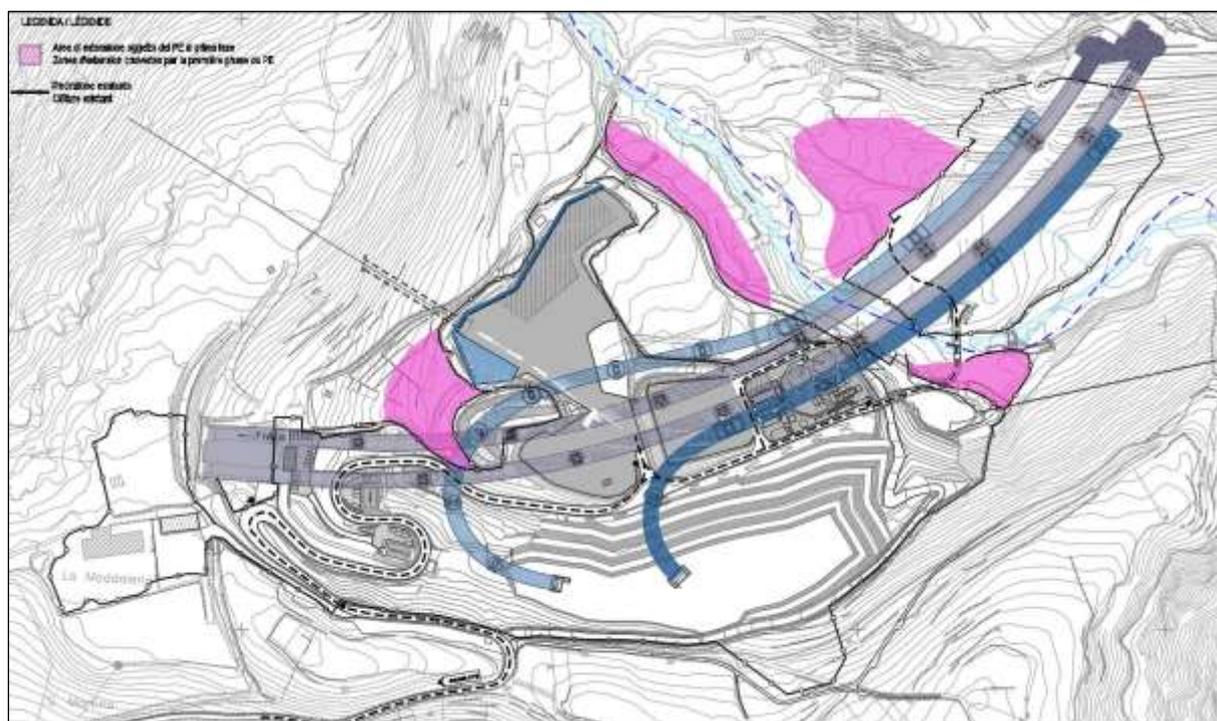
Maddalena aree oggetto dell'allargamento del cantiere
